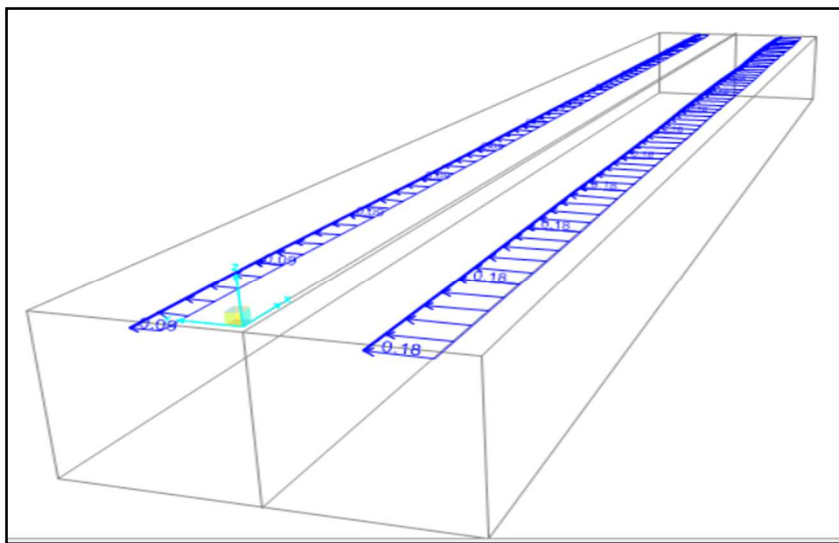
Imagen de las cargas de viento barlovento y sotavento.
